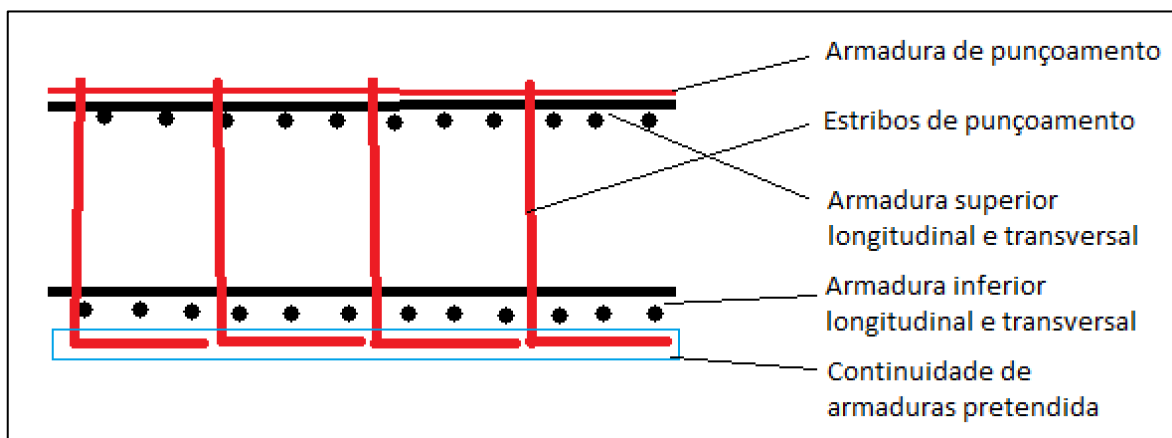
Esquema do corte transversal das armaduras de punçoamento (autor).
